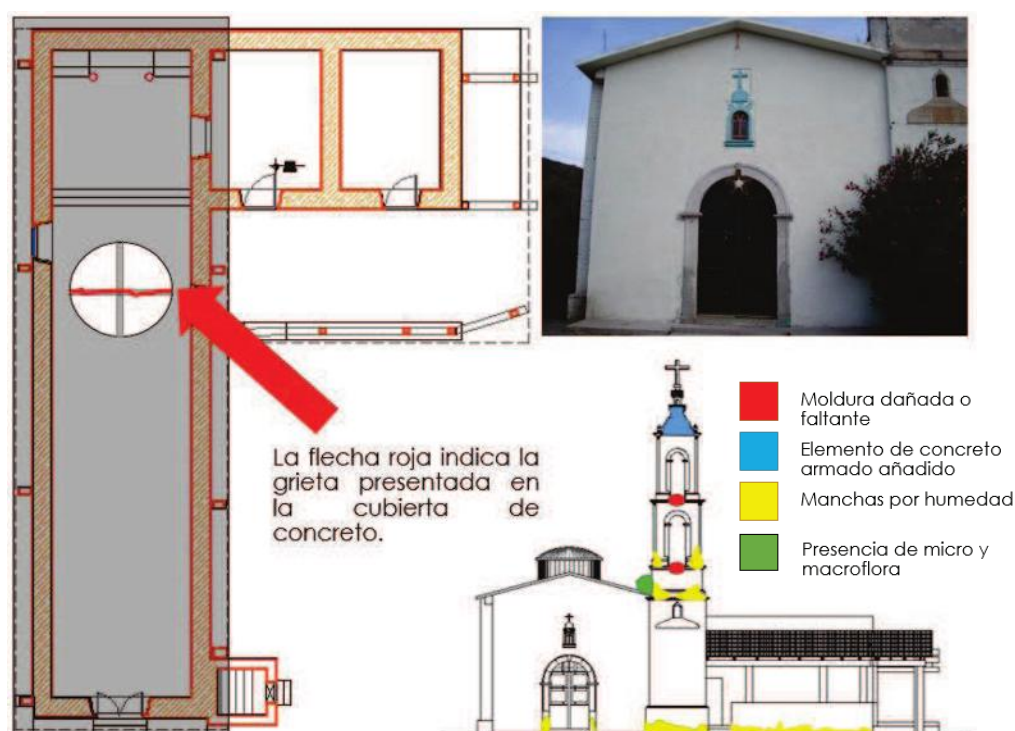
Indicación de grieta que presenta la cubierta de concreto. Elaboró: MRBR.
